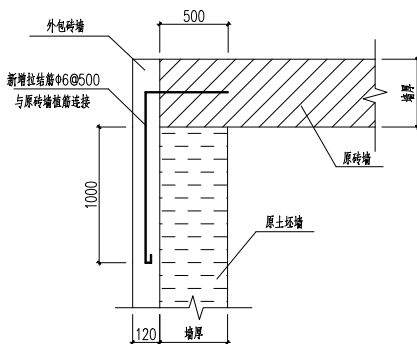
原有“一面青”砖墙和山墙外包砖墙 L 型钢钢筋植筋连接构造
